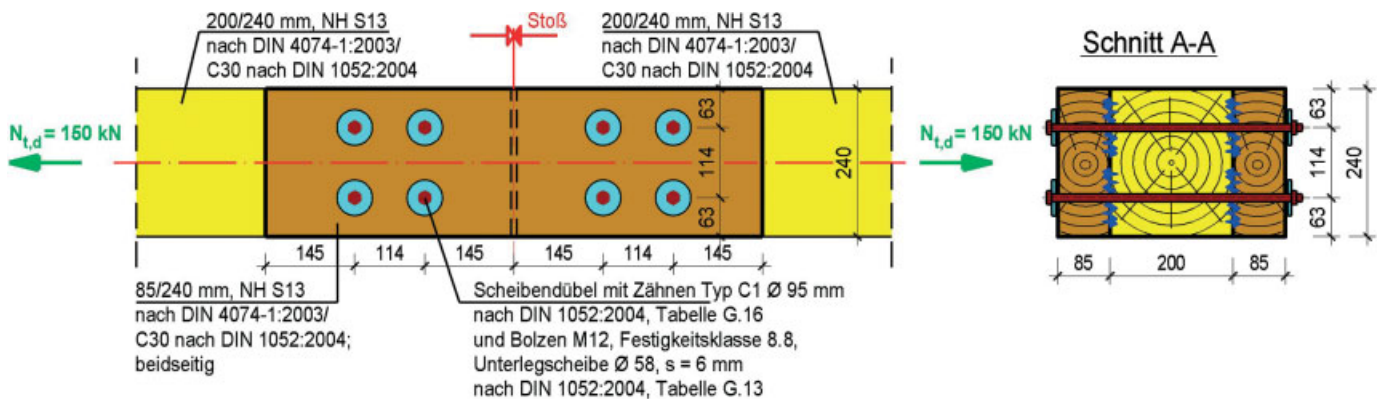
Verbesserte Konstruktion des Zugstoßes mit Laschen aus Nadelholz S13 nach DIN 4074-1 und Dübel besonderer Bauart Typ C1
